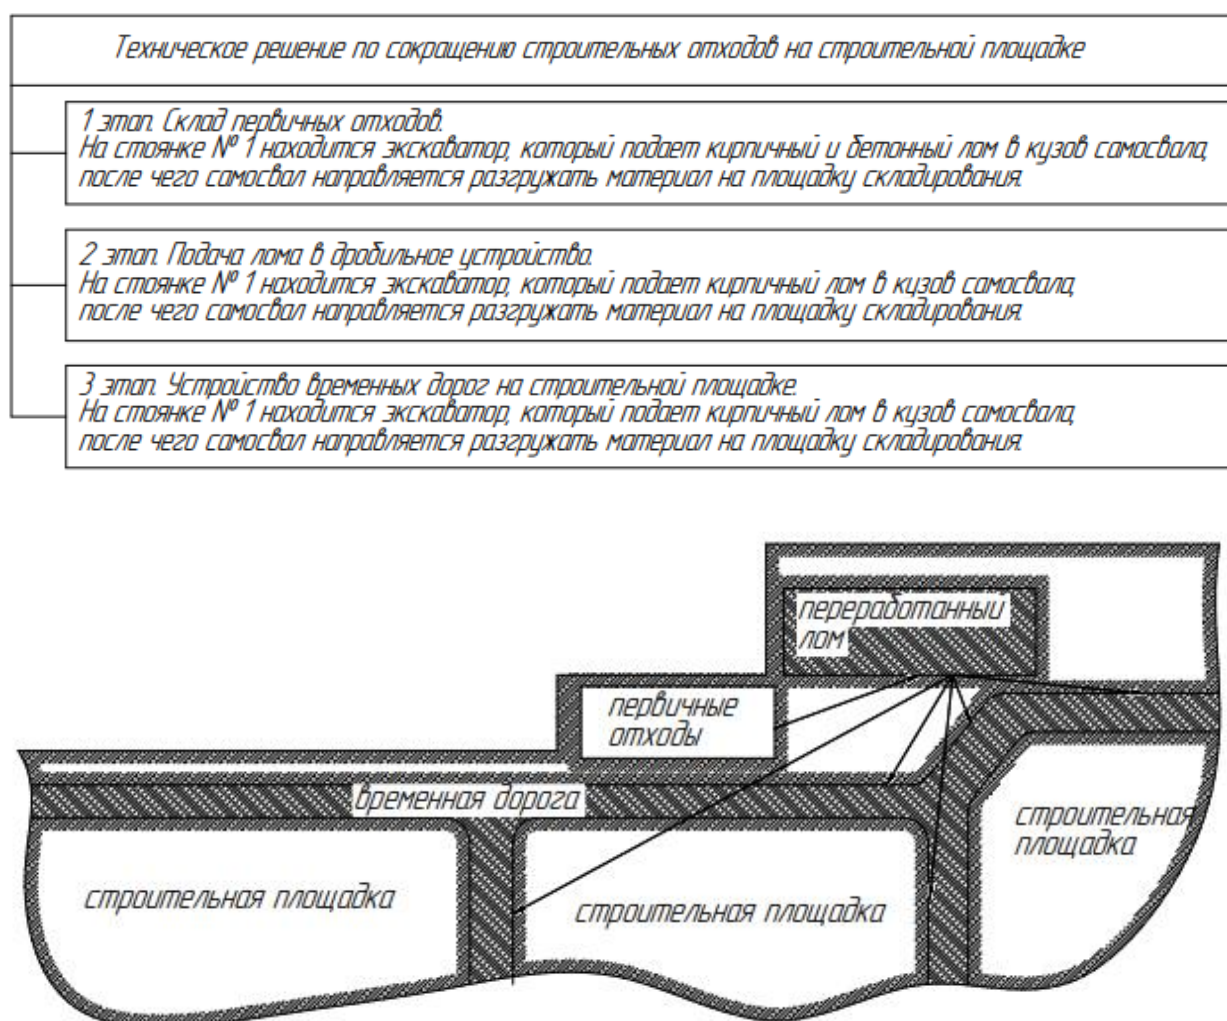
Схема переработки кирпичного и бетонного лома и устройства временных дорог на строительных объектах
